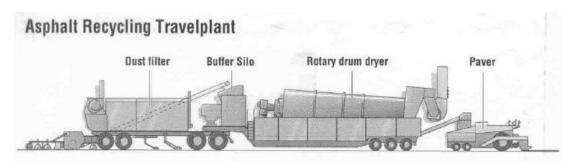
Planta móvil para reciclaje de mezcla asfáltica en caliente. (European Asphalt Pavement Association, 2005)
